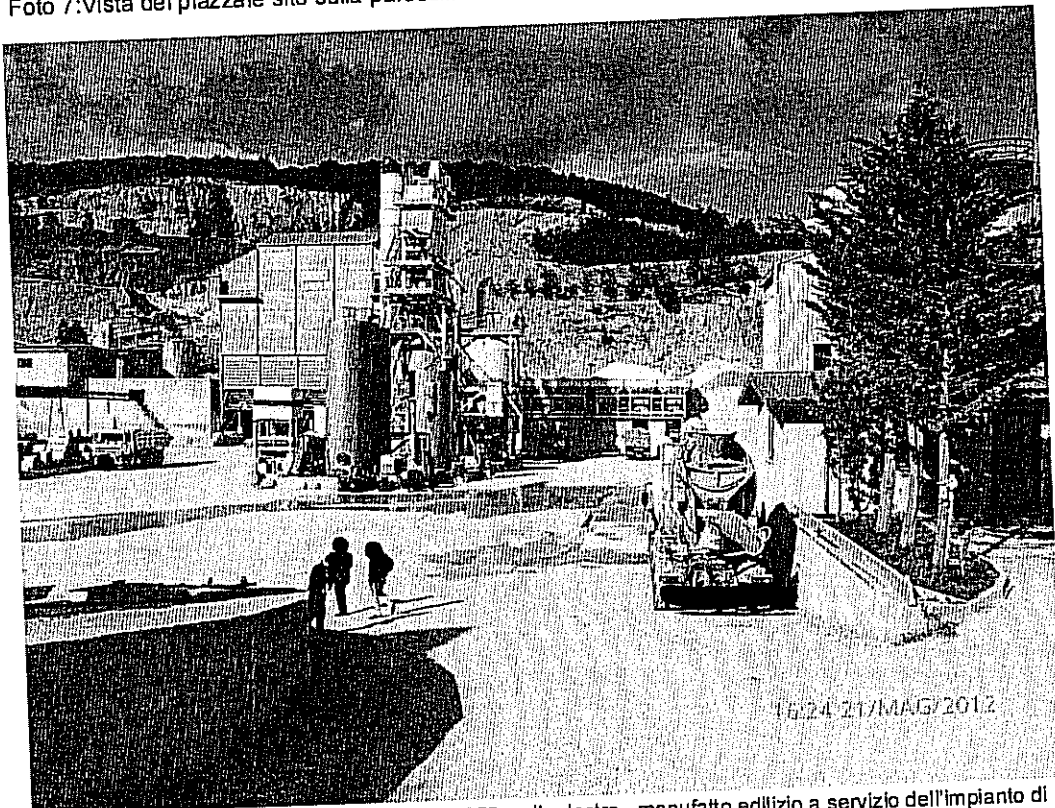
Vista del piazzale sito sulla particella 252, sulla destra manufatto edilizio a servizio dell'impianto di calcestruzzo
